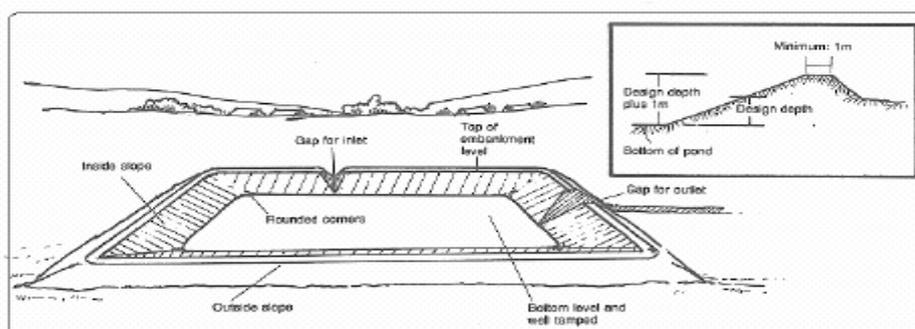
Construcción de terraplenes. (OPS/CEPIS/05.164)
